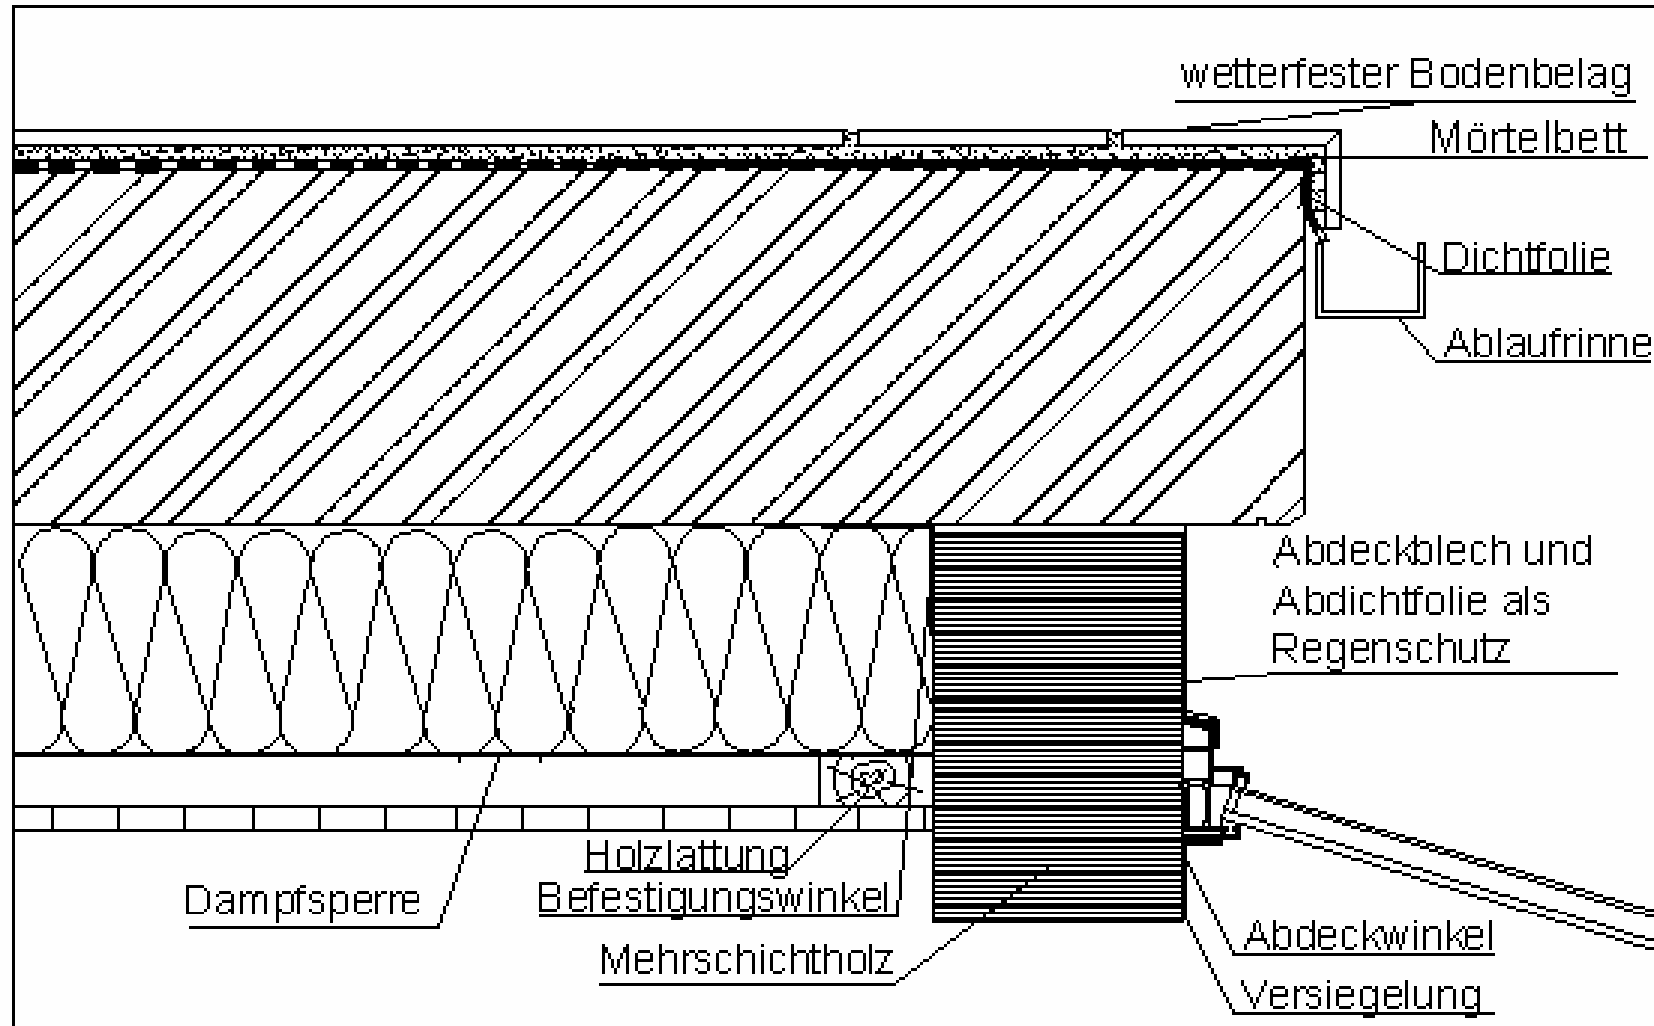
Dachanschluss an Balkonplatte, Aluminium-Wintergarten
